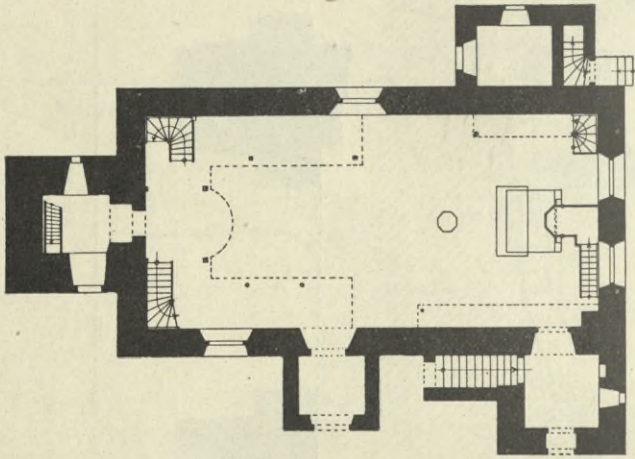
Kleinbautzen, Kirche, Grundriß.
